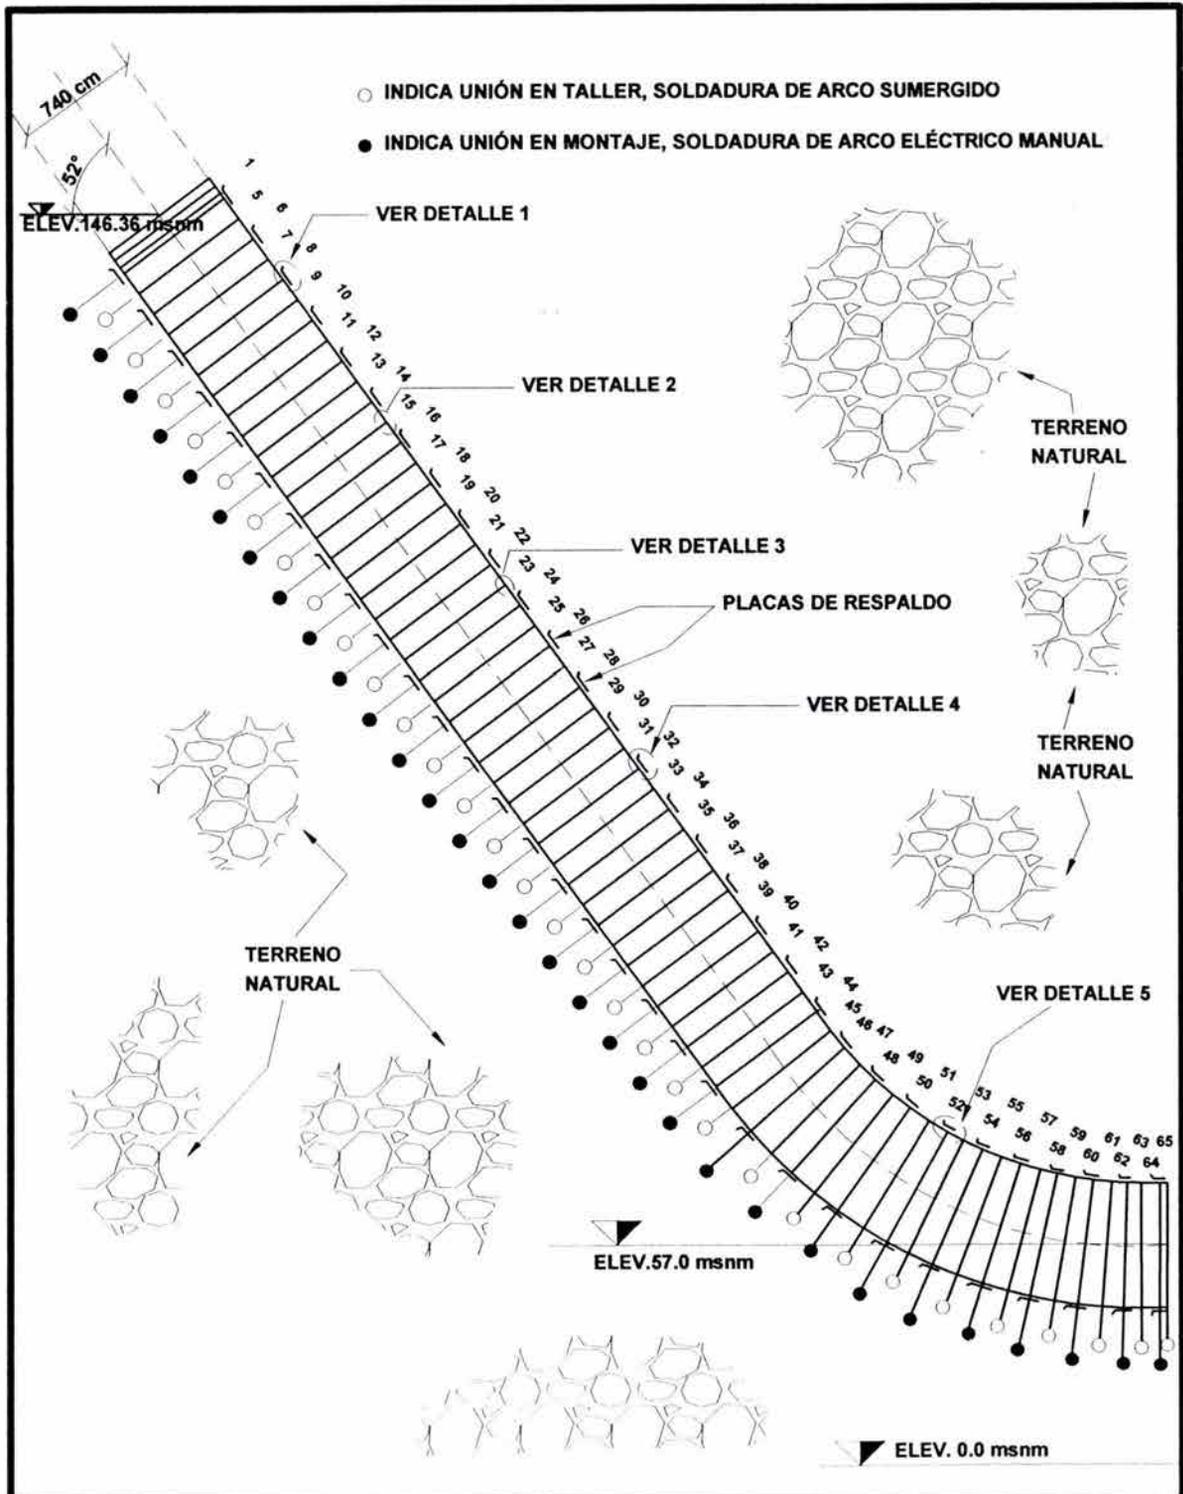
SOLDADURAS DE PREMONTAJE Y DE MONTAJE
